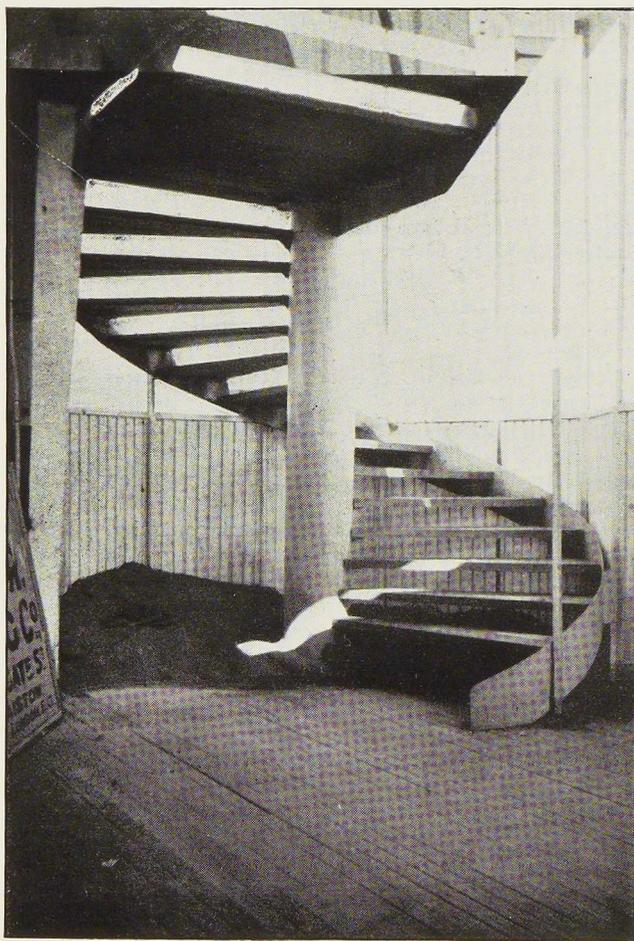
Vue d'un escalier d'entrée. Le poteau-support central est constitué par un tube métallique réalisé par soudure.
